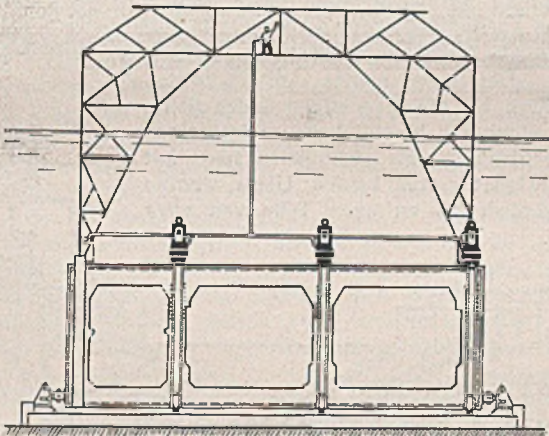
Vorübergehende Stützung eines Tunnelteils.
